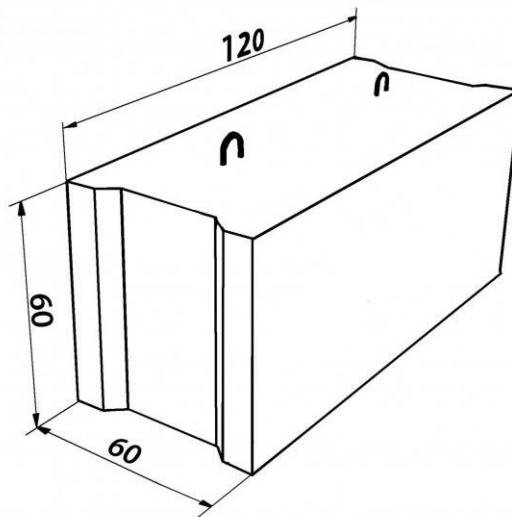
Фундаментний блок ФБС-12.6.6Т
